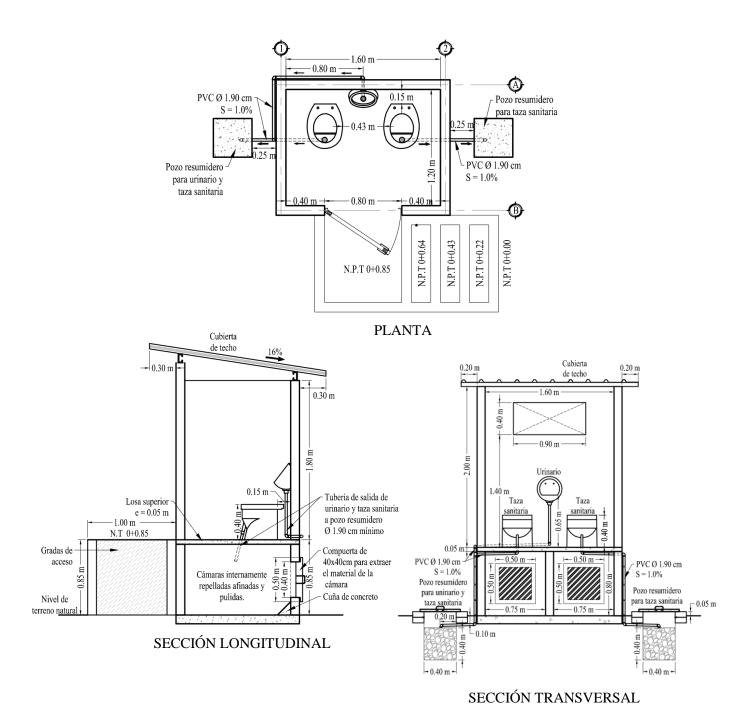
Vista en planta y elevación de los detalles constructivos de letrina de doble cámara
